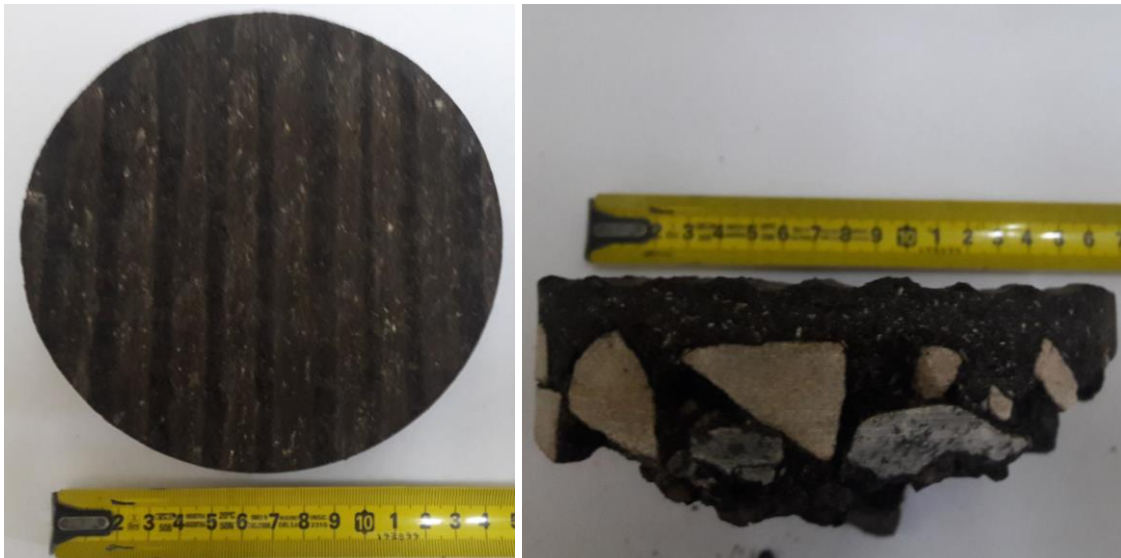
Planta y corte de un testigo extraído de un pavimento fresado
